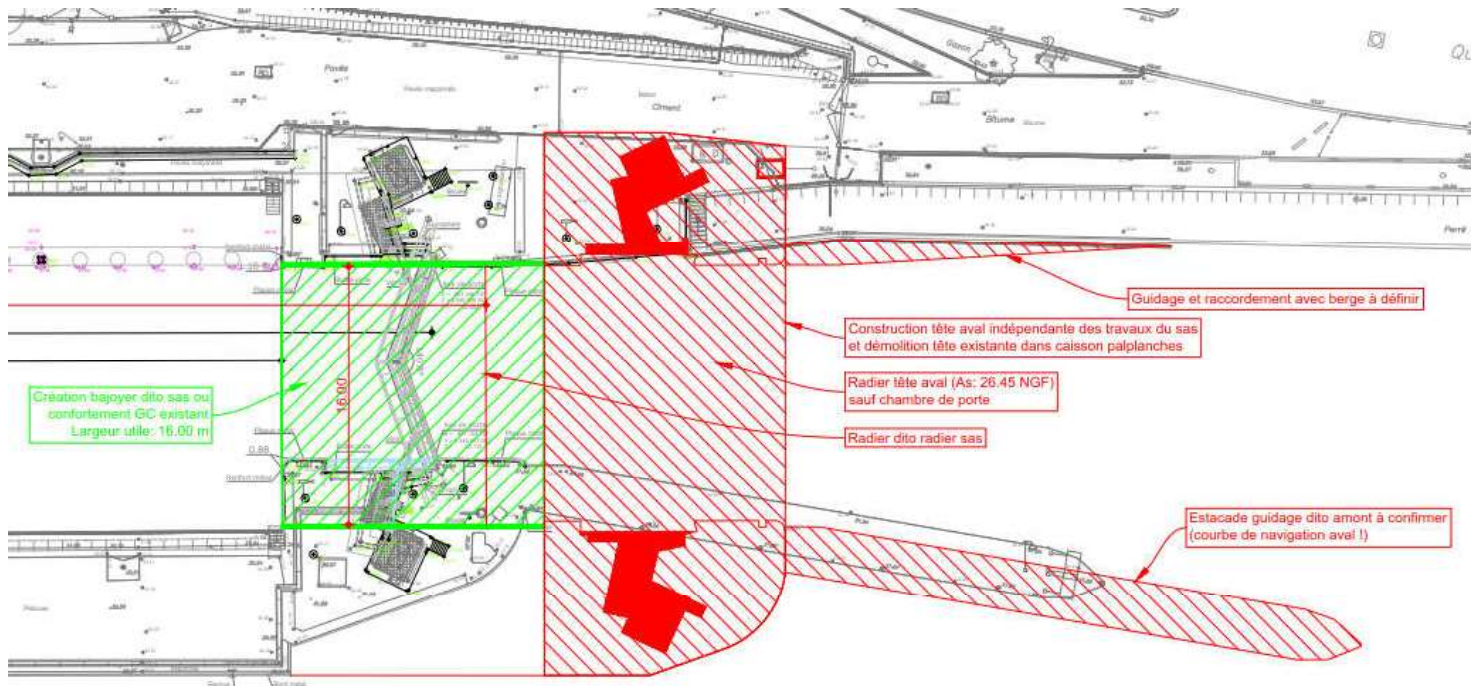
Croquis vue en plan de l'allongement de l'écluse avec démolition de la tête aval existante, largeur 16,00 m – Ouvrage indépendant des maçonneries existantes
